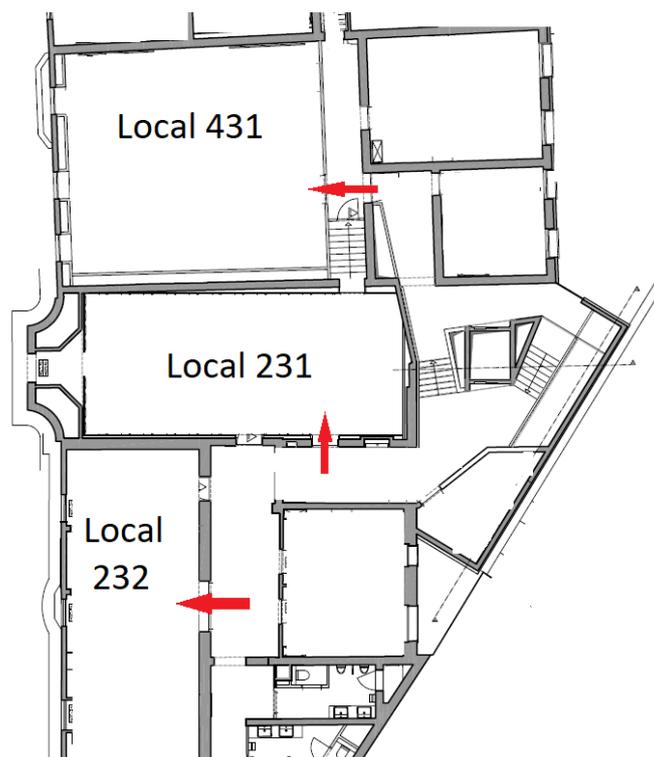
Plan des locaux du 3<sup>e</sup> étage. Copyright © 2020 ICHEC Brussels Management School
